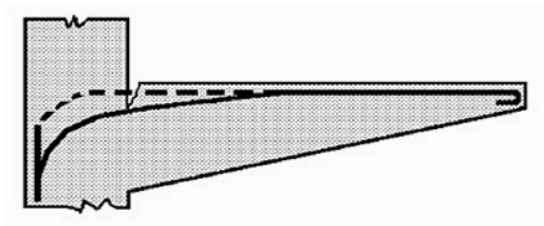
Fissura causada pelo deslocamento da armadura principal, em relação à posição original.
